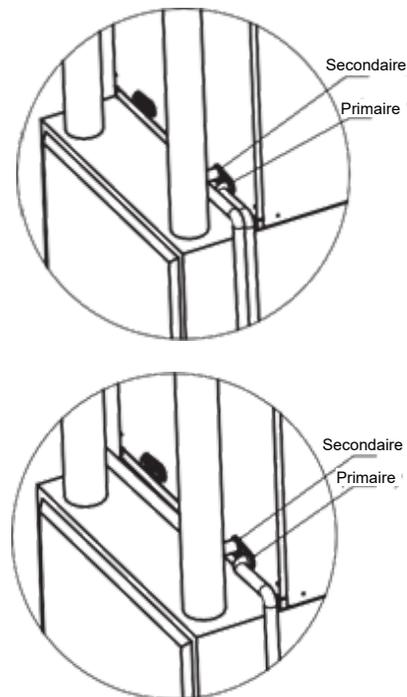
ACHÈMÈNEMENT DU TUYAU DE DRAINAGE
